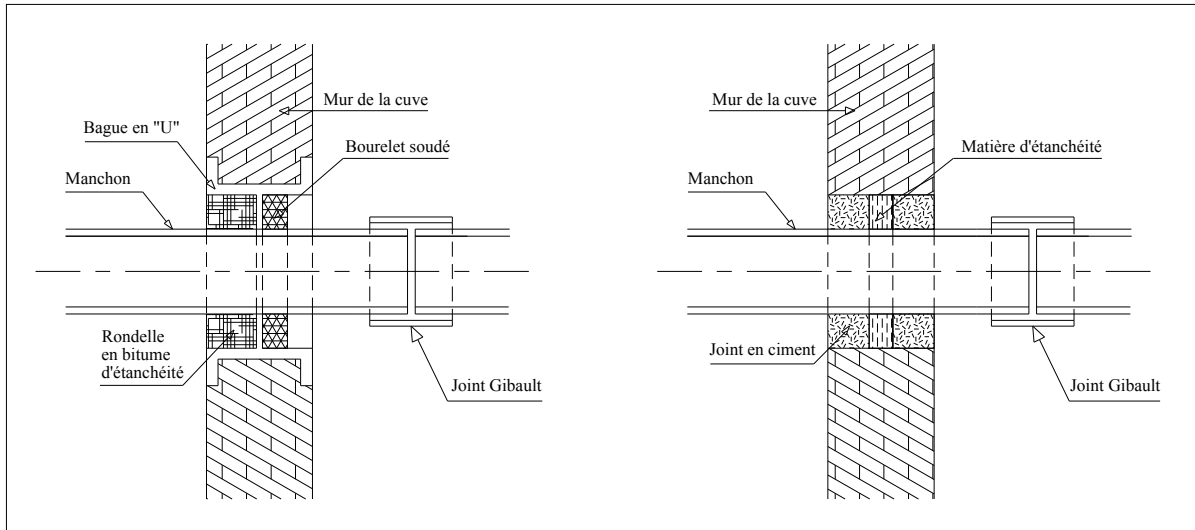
a: Traversée des conduites (manchon à bout lisse)
